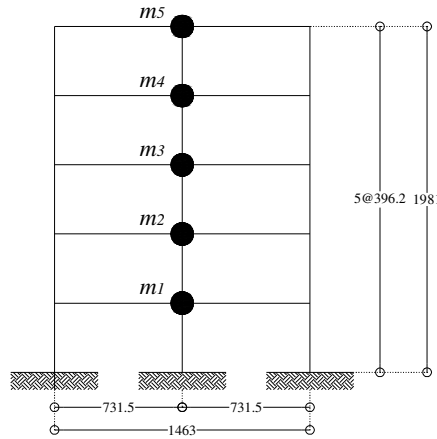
Modelo M1, marco plano de concreto reforzado 5 niveles (cm)
